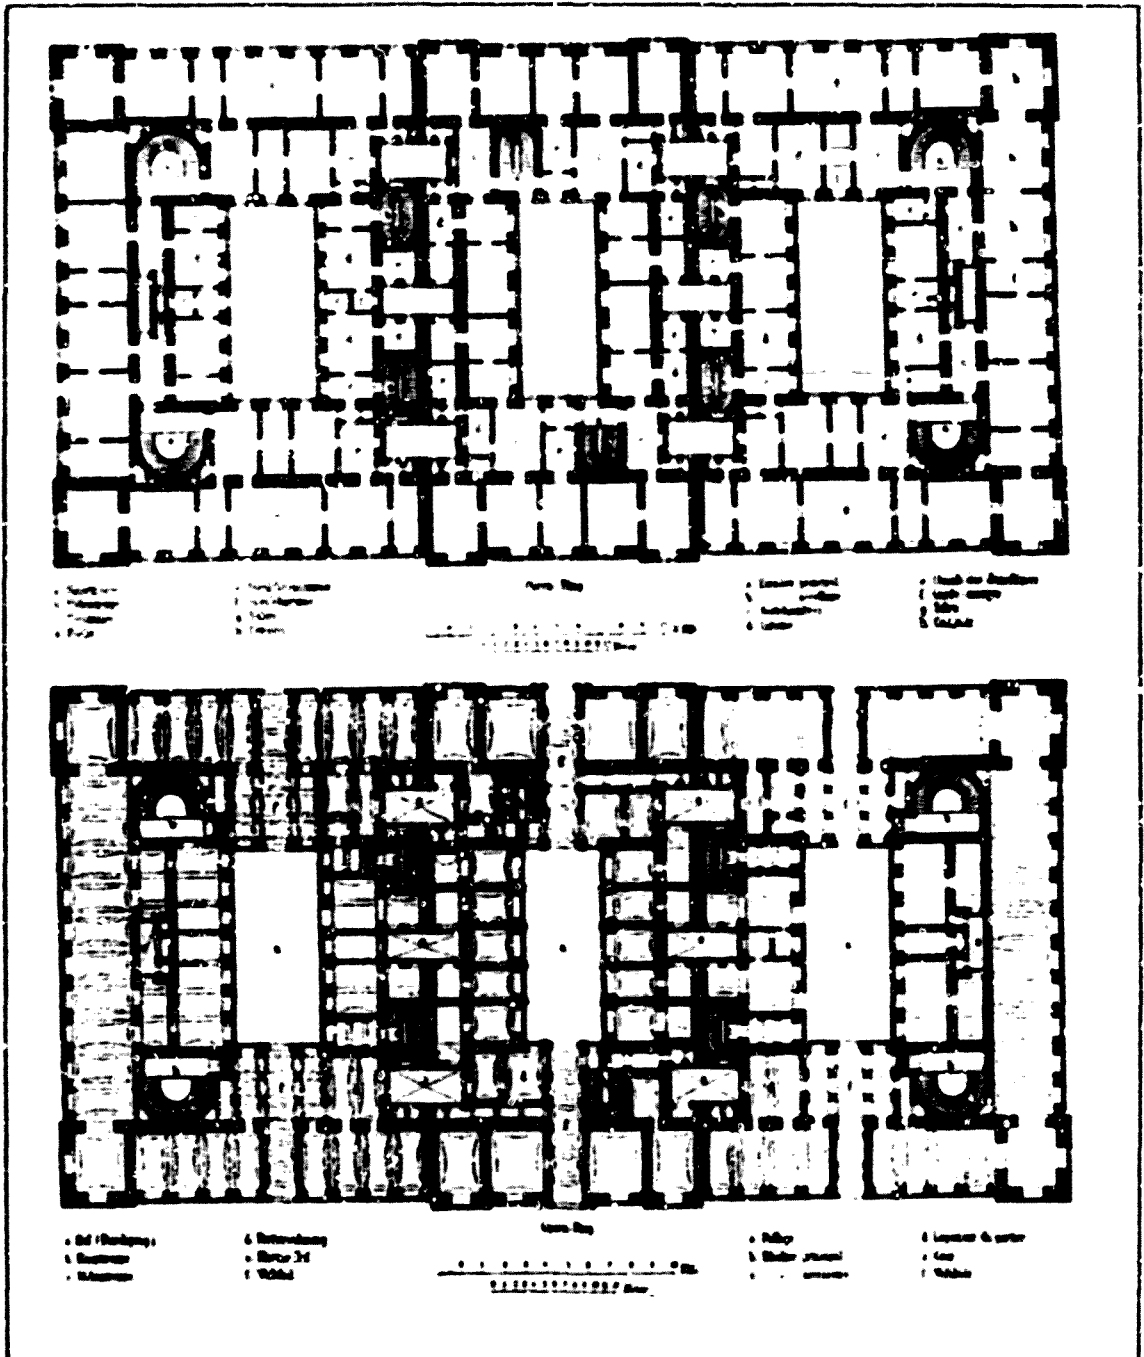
Heinrichhof. Planta baixa (a sota) i primer pis (a sobre)
